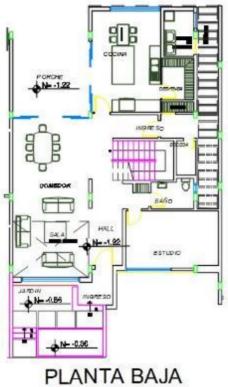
Casa 8 - planta baja Elaborado por: Carolina Calupiña M
